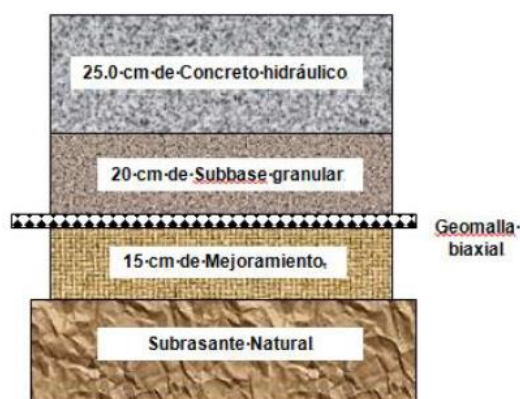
Diseño Pavimento rígido segundo sector – abscisa K1+000 a la Glorieta Las Brisas.
